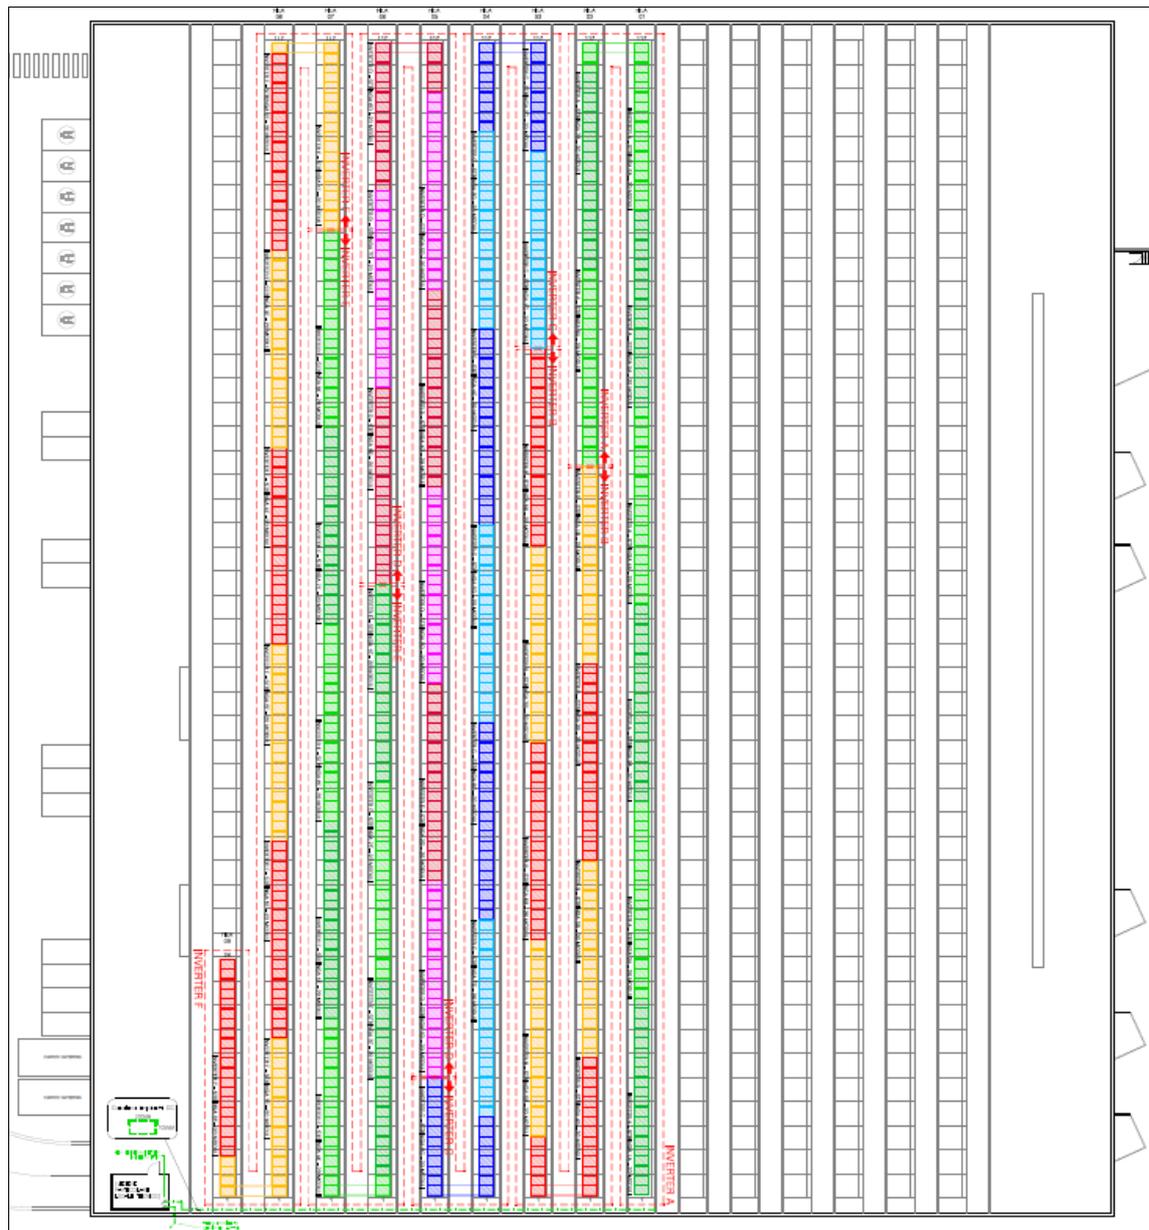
Pianta ubicazione impianto di conversione fotovoltaica
